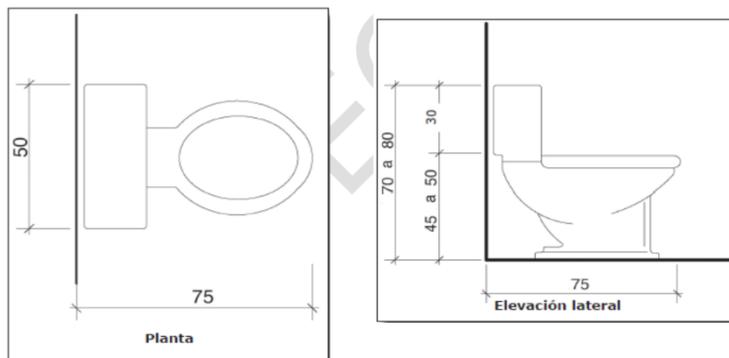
Inodoro - Dimensiones (Dimensiones en cm)
